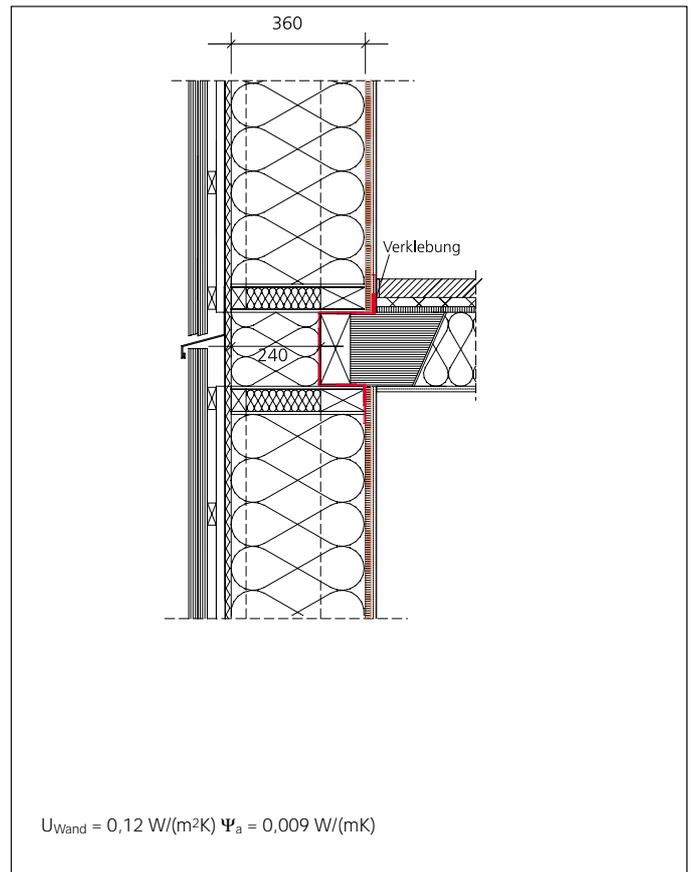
Anschluss Decke an Außenwand. Wird die Stoßstelle mit einer genügend dicken Dämmschicht überdeckt (Regel vom breiten Stiff), ist die Wärmebrückenwirkung vernachlässigbar. Ein breiter Folienstreifen, der im unteren Wandelement eingeklemmt ist, wird nach dem Auflegen der Balkendecke nach innen geschlagen und später mit der Beplankung des oberen Wandelement im Bereich des Estrichs verklebt.
